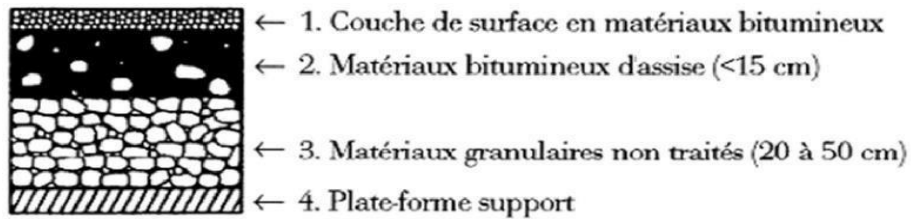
Représentation de la structure d'une chaussée souple [5]
